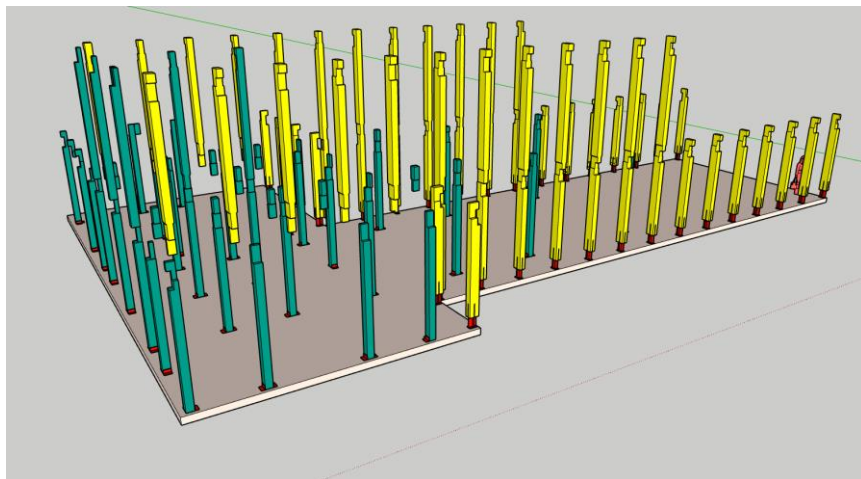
Последовательность монтажа каркаса – установка деревянных колонн
